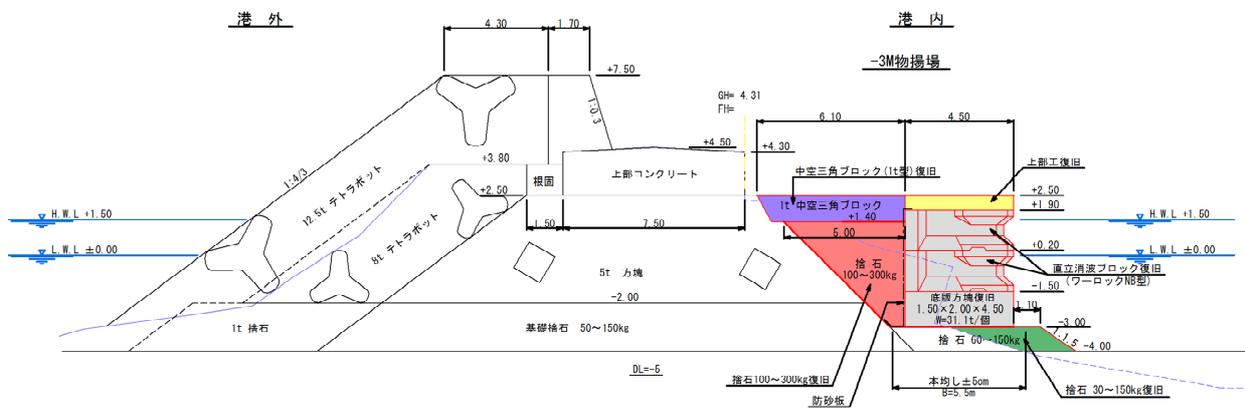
No.31 大洗港区_第1ふ頭 A-2 物揚場 (-4.0m) の断面図 (復旧後)
